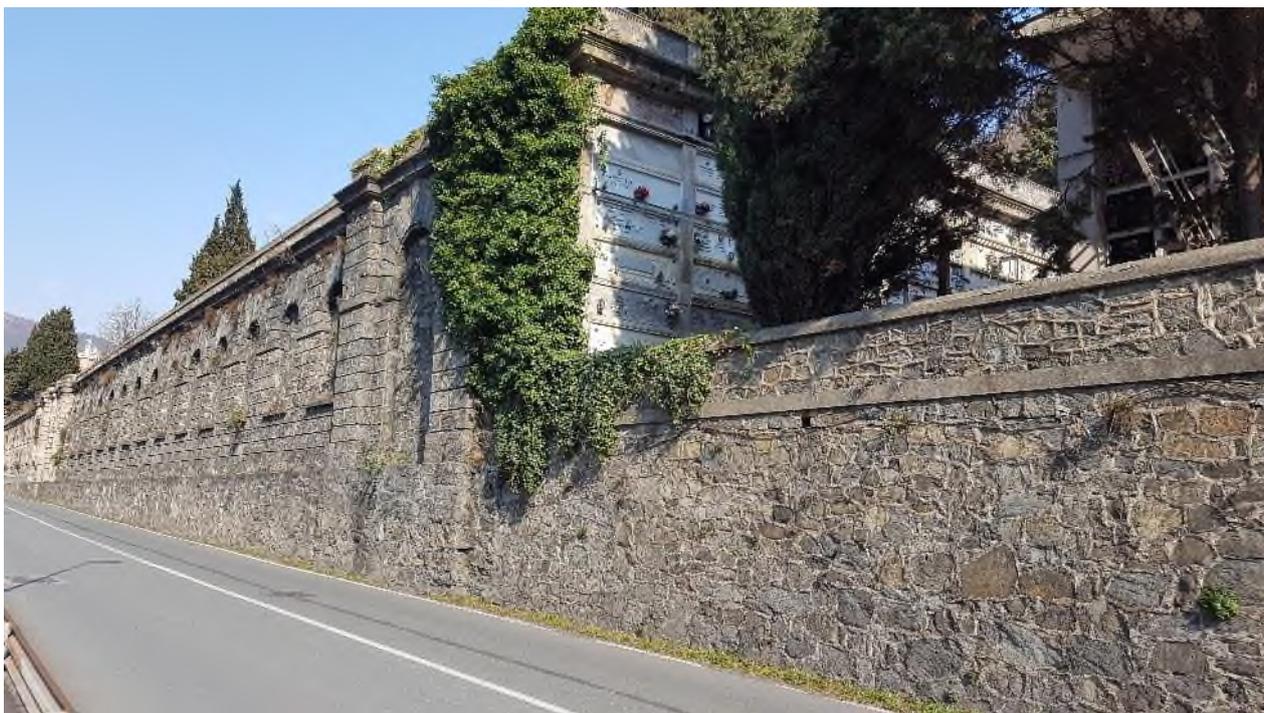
Intervento 1- Fronte principale, parete con rivestimento in pietra.
